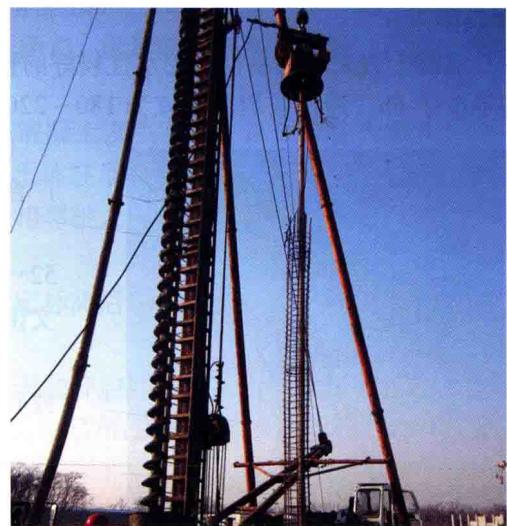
钢筋笼在振动锤的作用下插入桩身混凝土中
